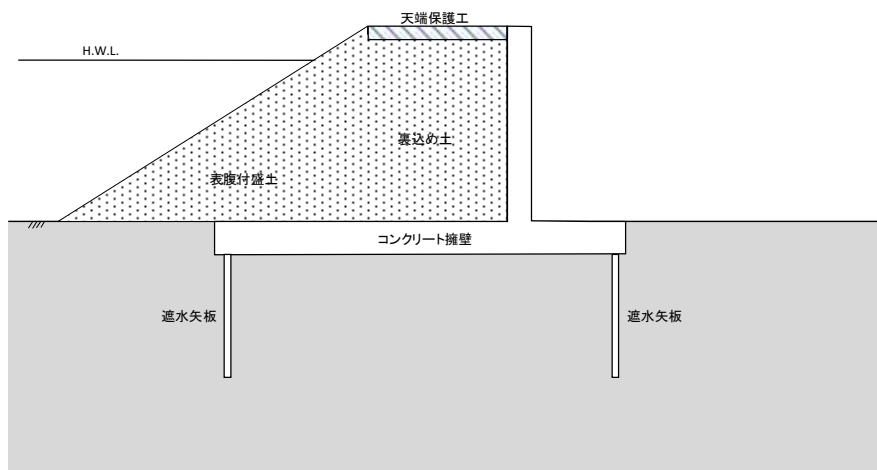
コンクリート擁壁の代表的な構造（逆 T 型直接基礎形式）
